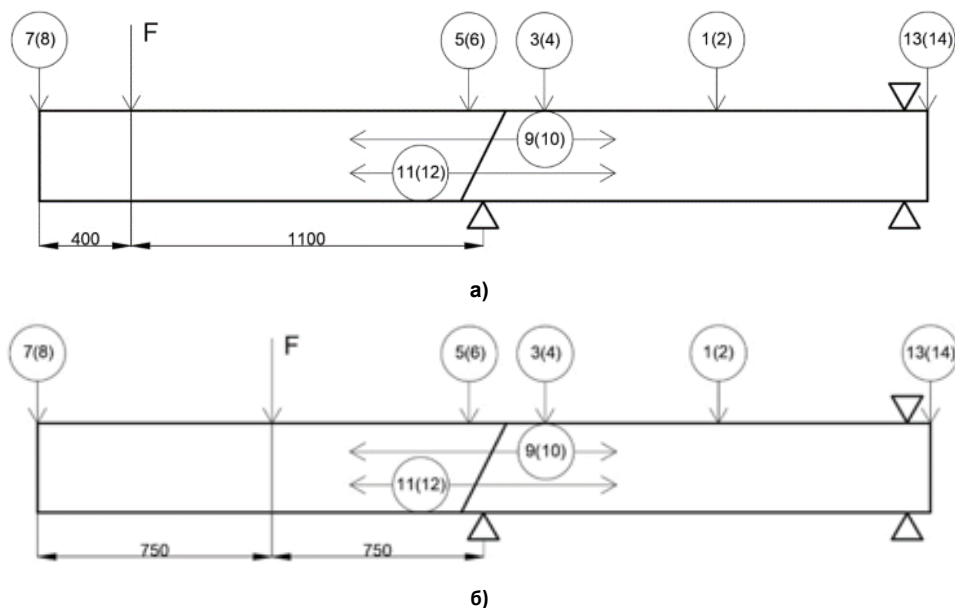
Схемы нагружения фрагментов: а – схема № 1, б – схема № 2
